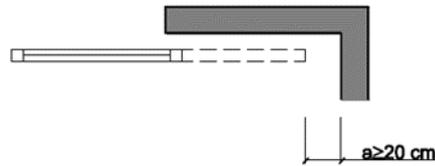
Espacio entre apertura de las puertas correderas frente al elemento fijo más cercano.
